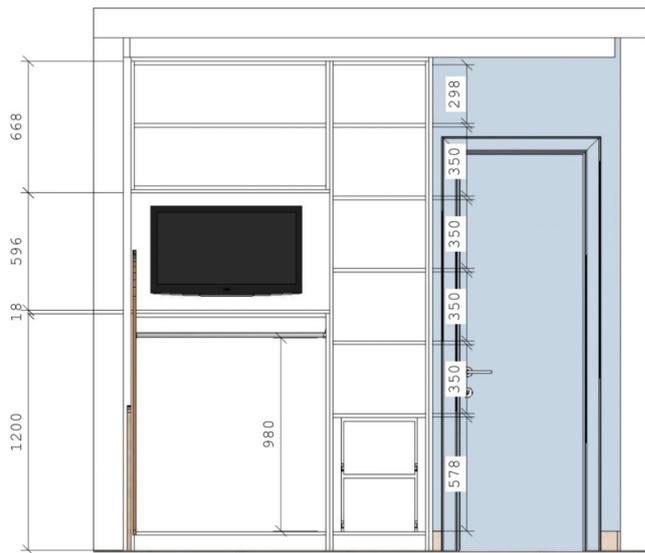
Detalhamento imagem 4. Fonte: Autora.
